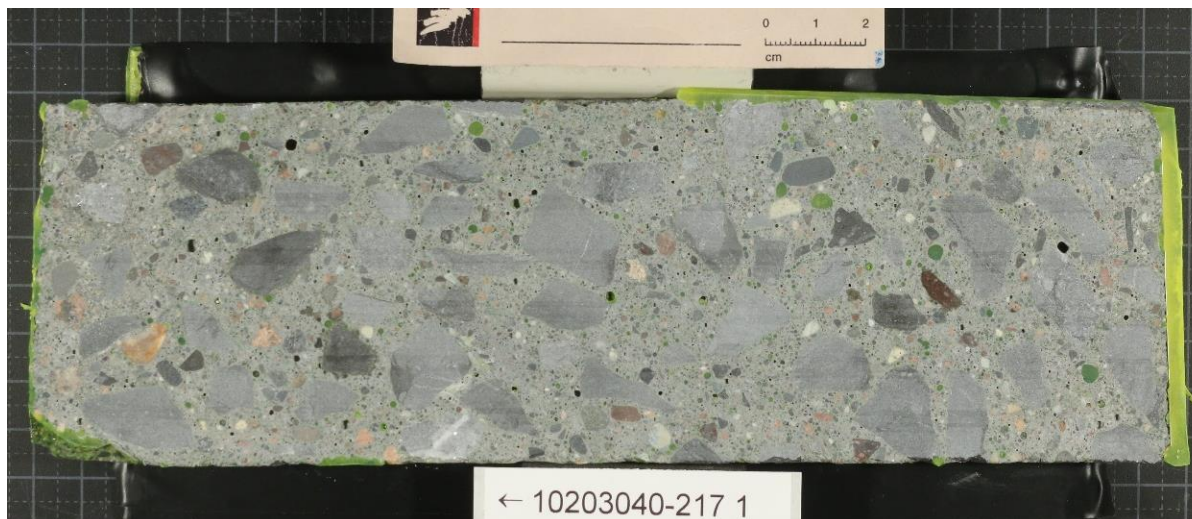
Planslipet fra kjerne 1 (total plansliplengde 225 mm – "overflaten" til venstre på bildet).
